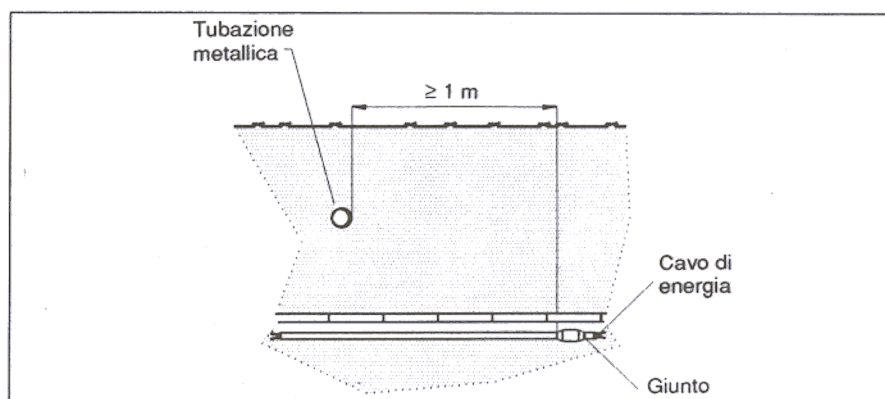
Le connessioni sui cavi devono distare in pianta almeno 1 m dal punto di incrocio con tubazione metallica
